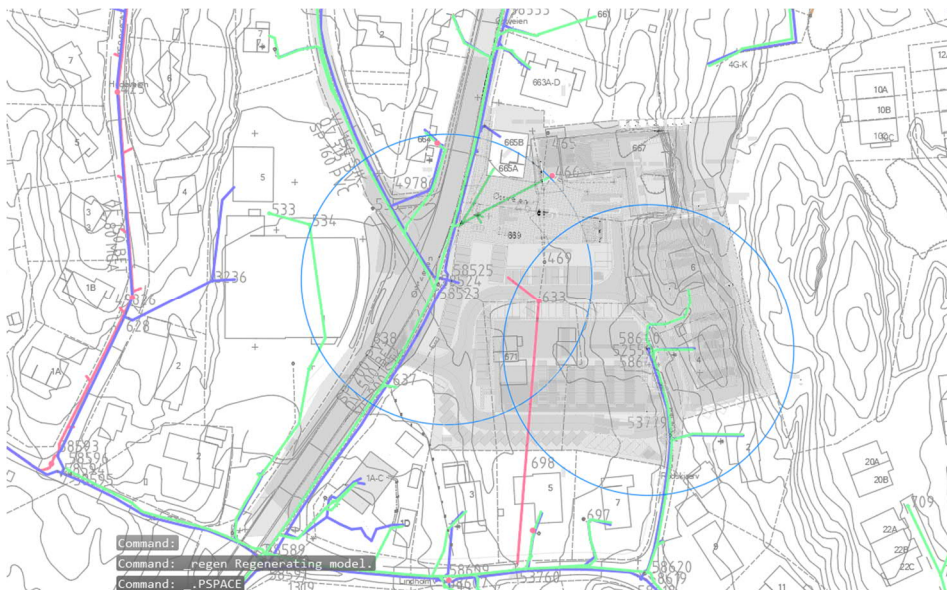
viser planområdet med eksisterende VA ledningssystem. Gulmarkert merknad viser mulig tilkobling for vann til ny bebyggelse.
